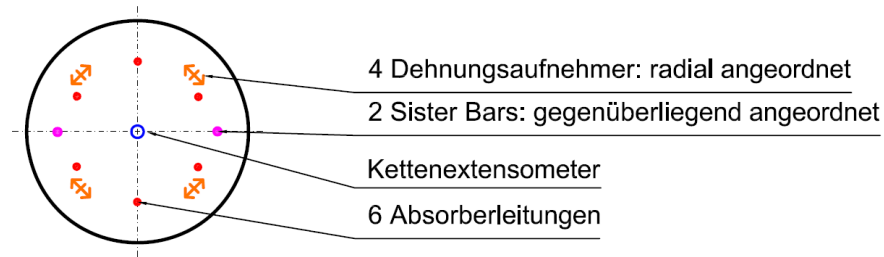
Querschnitt mit Instrumentierung des Kiespfahls [58]
